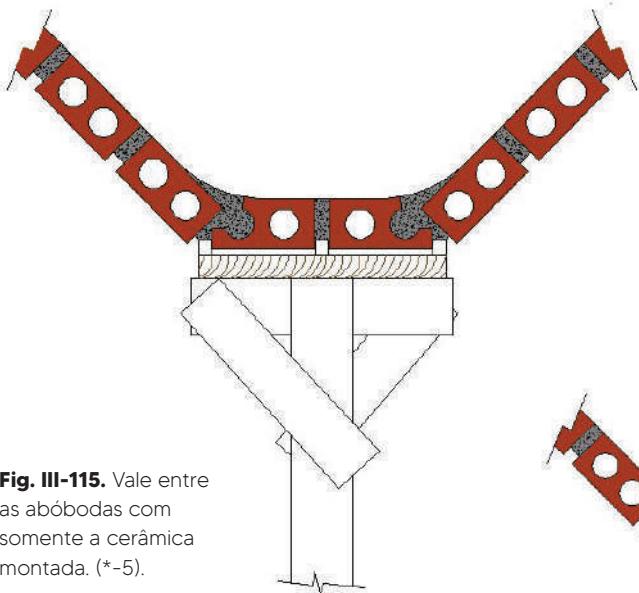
Vale entre as abóbodas com somente a cerâmica montada. (*-5).
